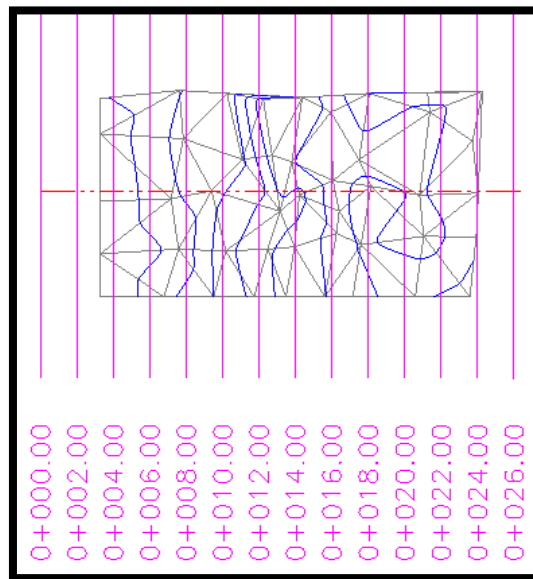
Levantamiento topográfico del terreno en planta.
